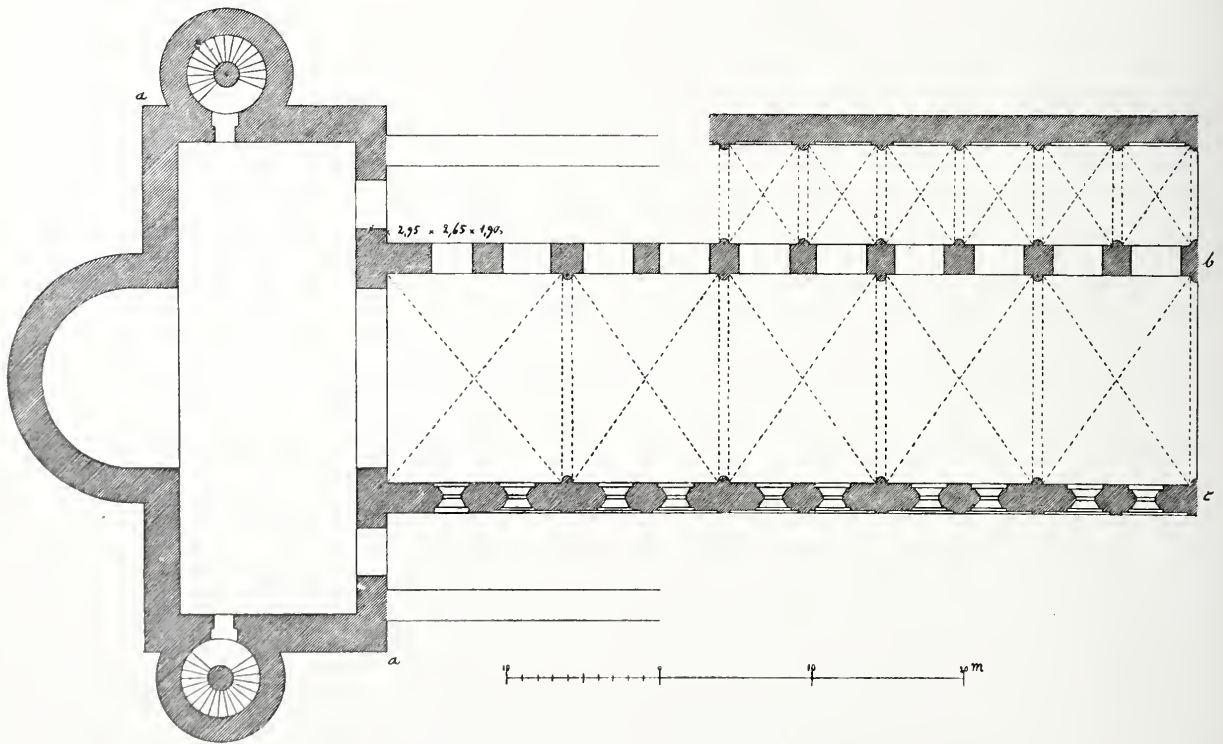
Grundriss des Domes zu Mainz.
